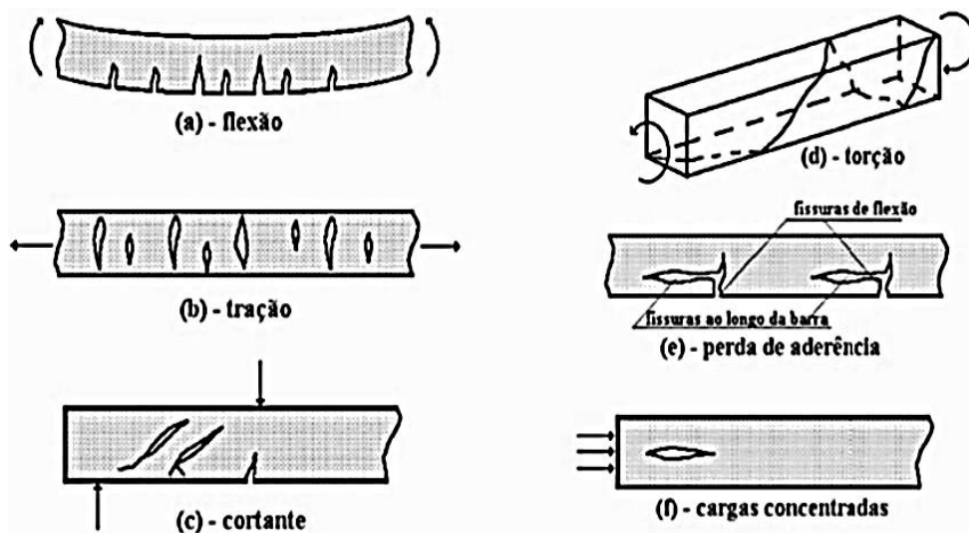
Fissuras devidas a cargas mecânicas (Souza, 1998)
